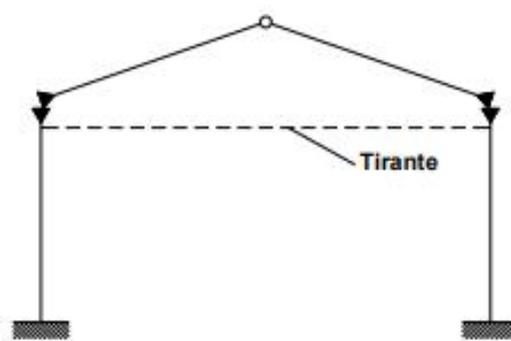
Pilares engastados na fundação e dois elementos de cobertura articulados
